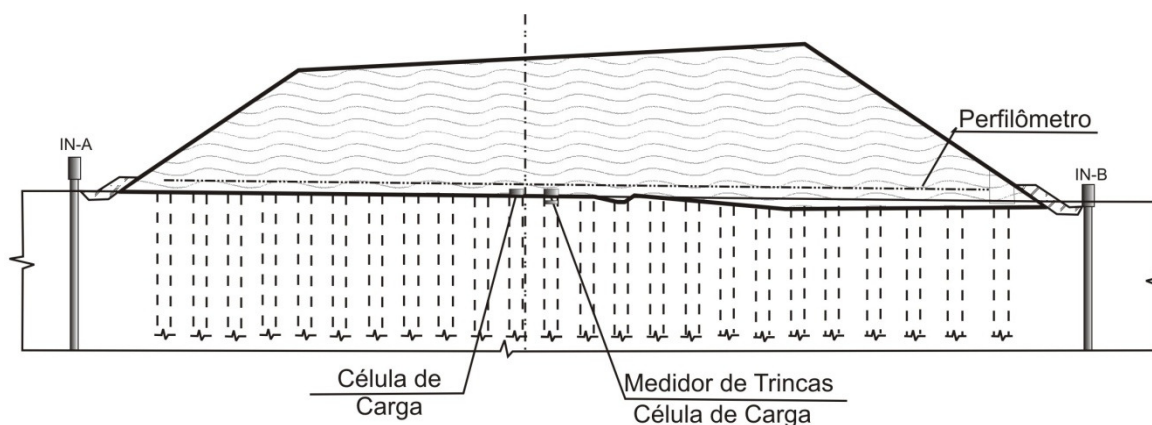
Seção transversal instrumentada da rodovia que liga as rodovias Presidente Dutra e Ayrton Senna (Modificado - de Mello *et al.*, 2008).
